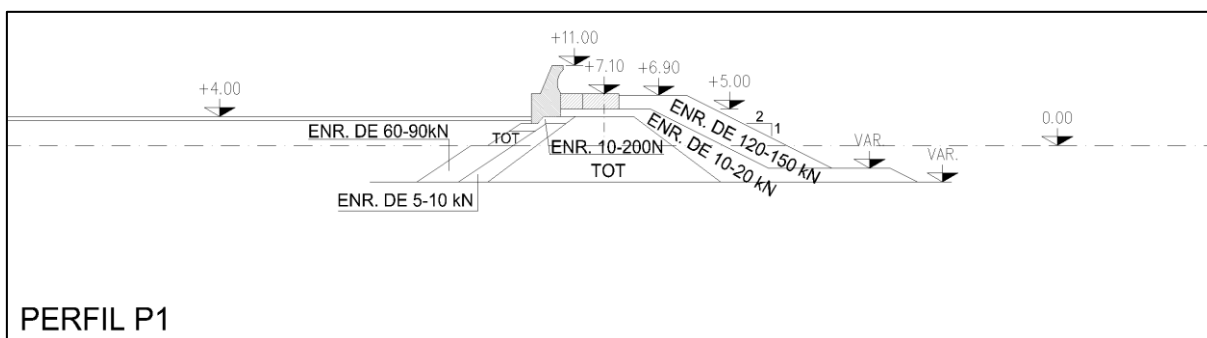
Perfil Transversal Tipo P1, construído em 1985
